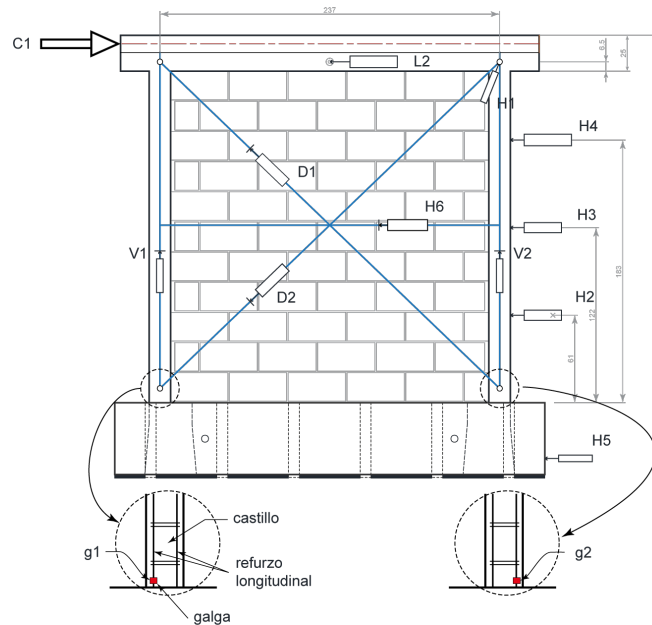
Instrumentación externa de muros, galgas en refuerzo longitudinal de castillos de los muros MH8R1-MH8R3
